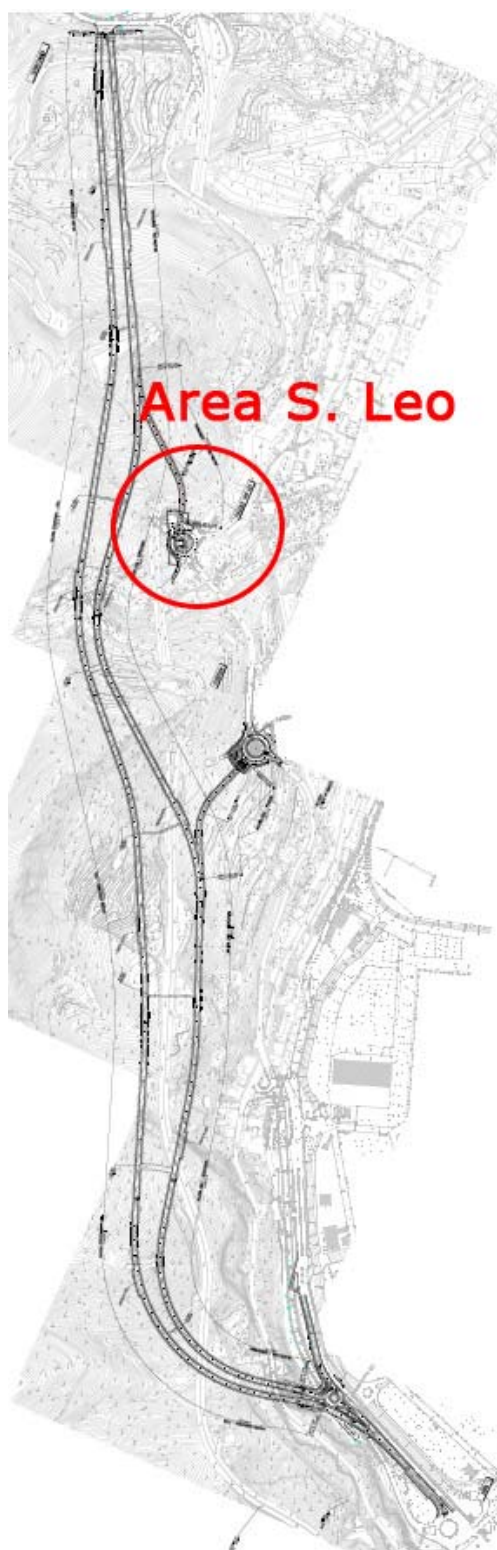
Planimetria di Progetto Esecutivo, area San Leo
